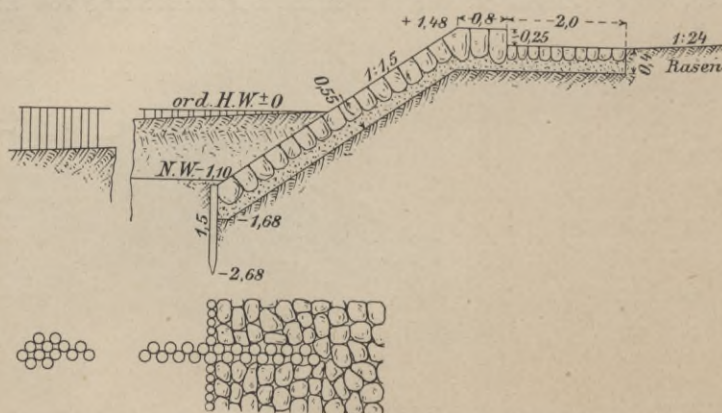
Pfahlbuhnen und Böschungspflaster mit Wasserkissen auf Hallig Oland Querschnitt und Grundriss.
